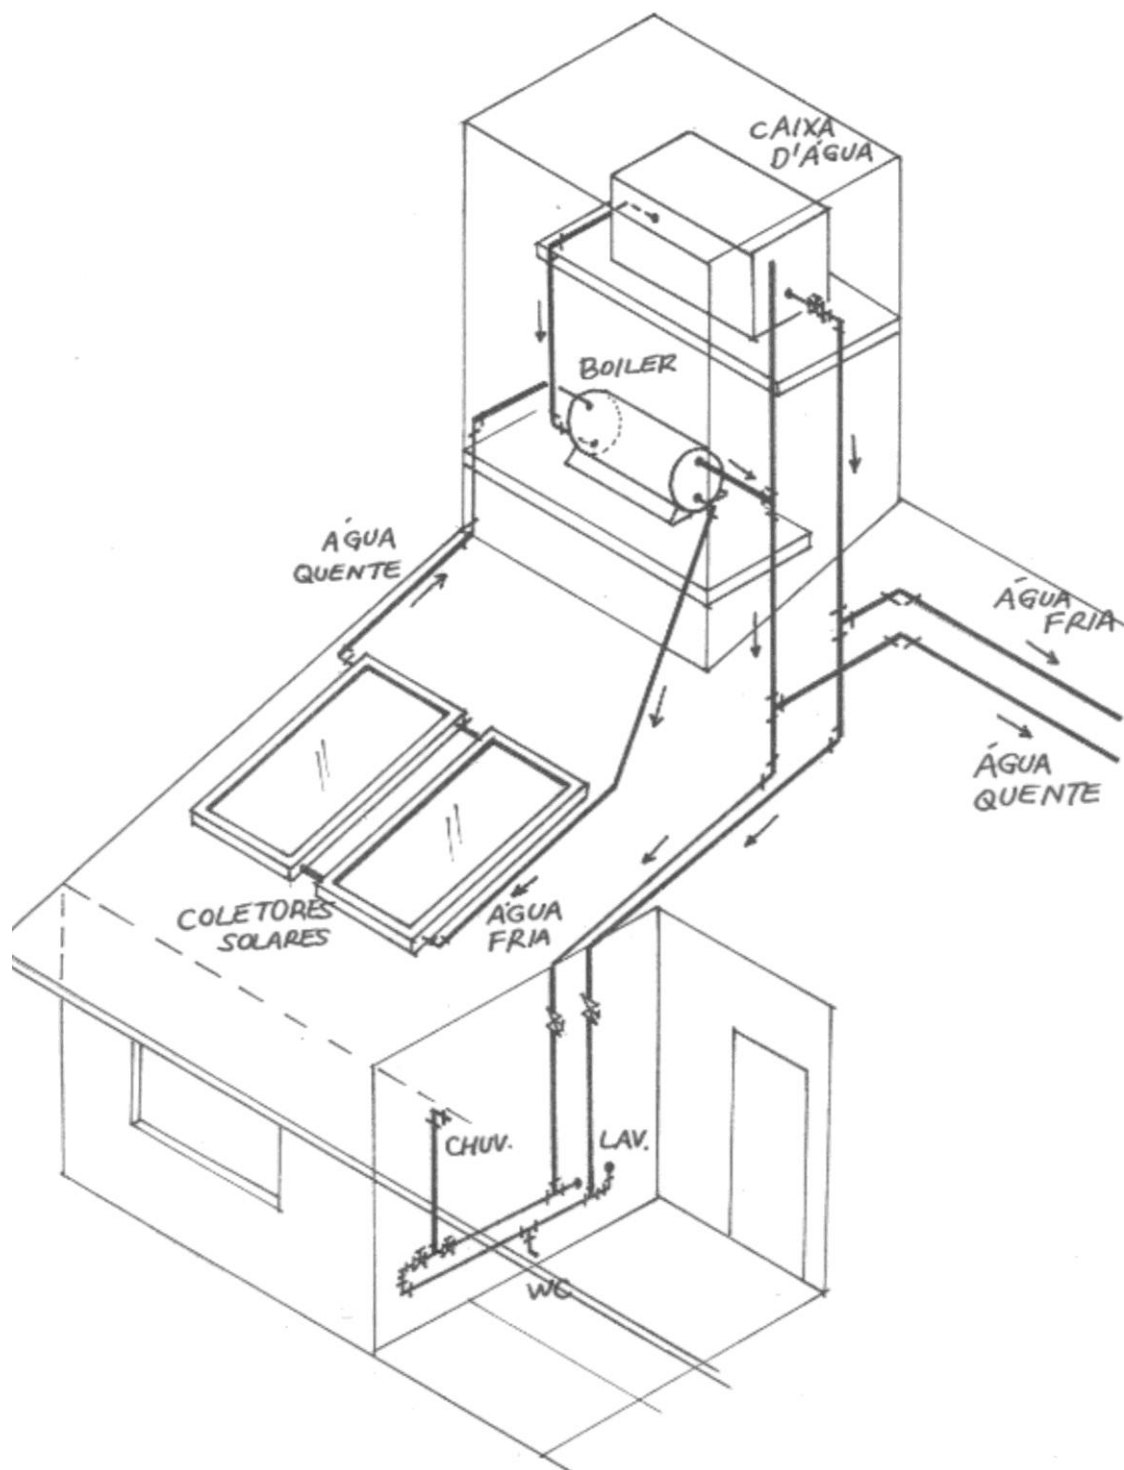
Desenho esquemático de uma instalação hidráulica com aquecimento solar.
